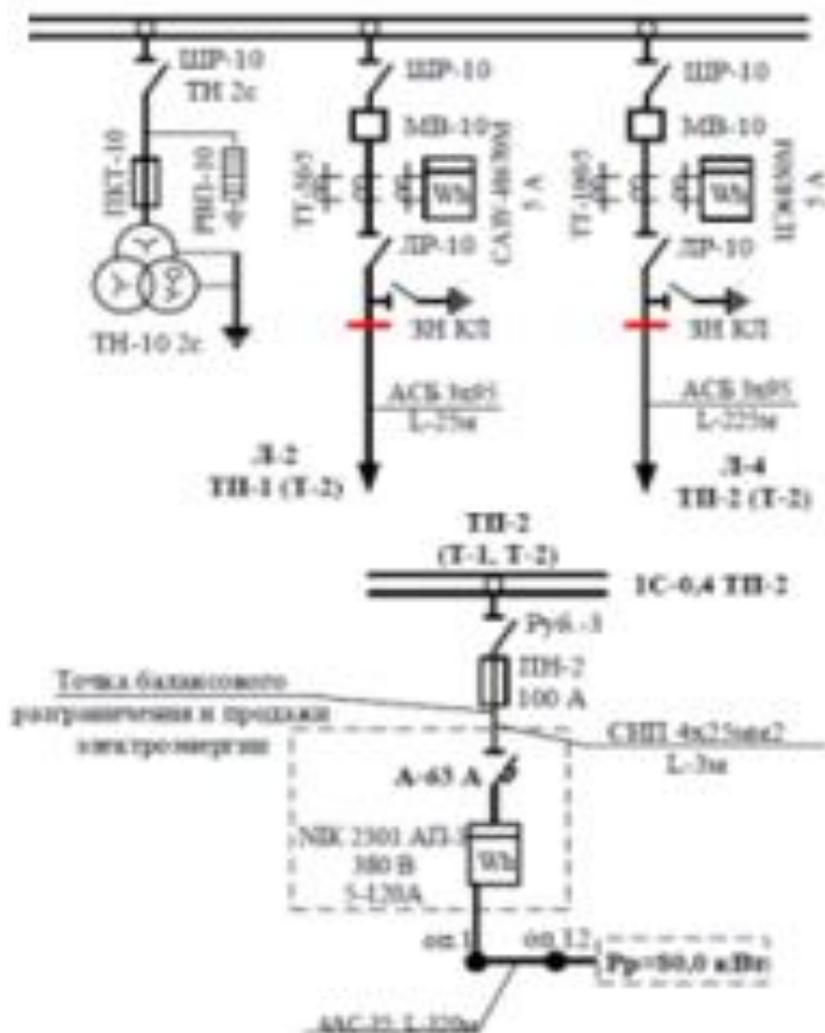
Схема электроснабжения КОС п. Шарипово
